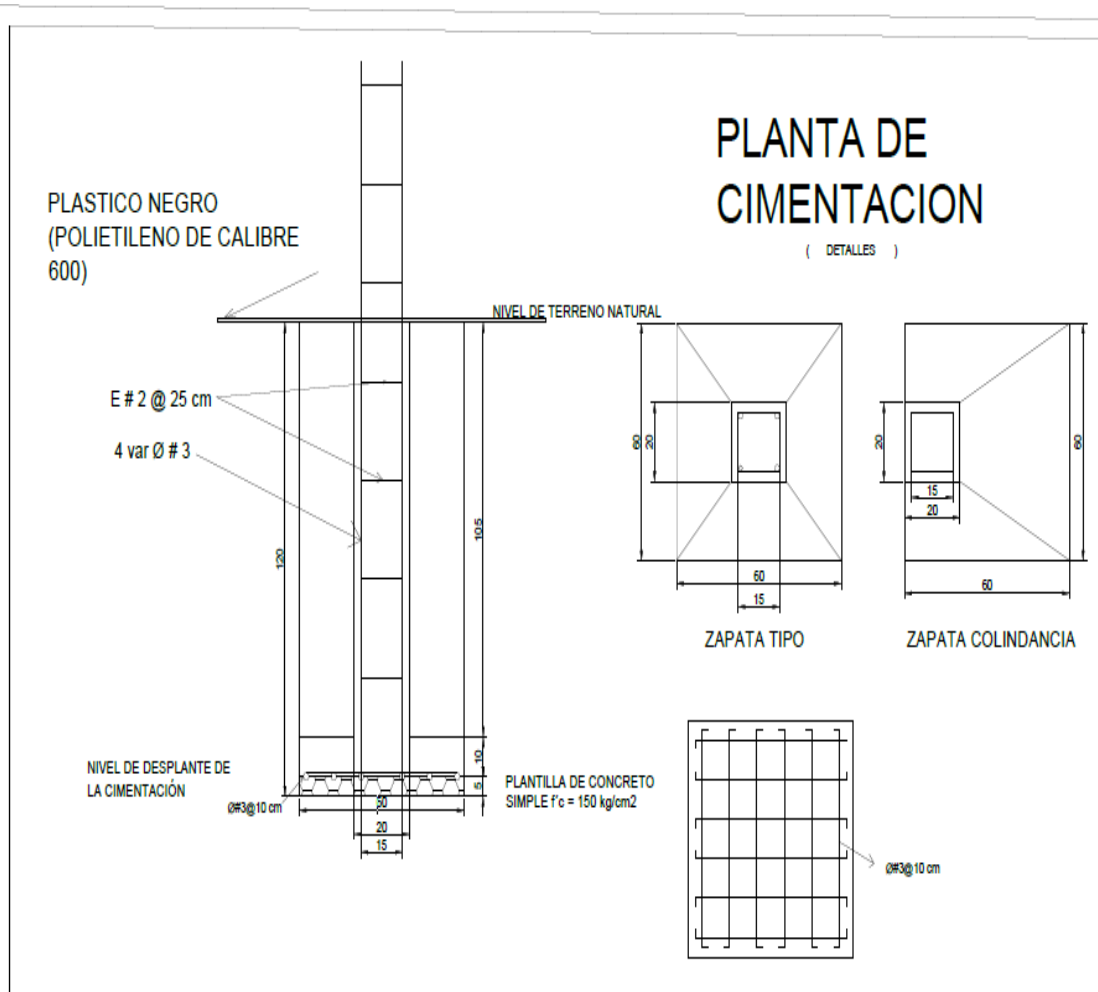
Plano de cimentaciones (ver anexos para plano completo).
